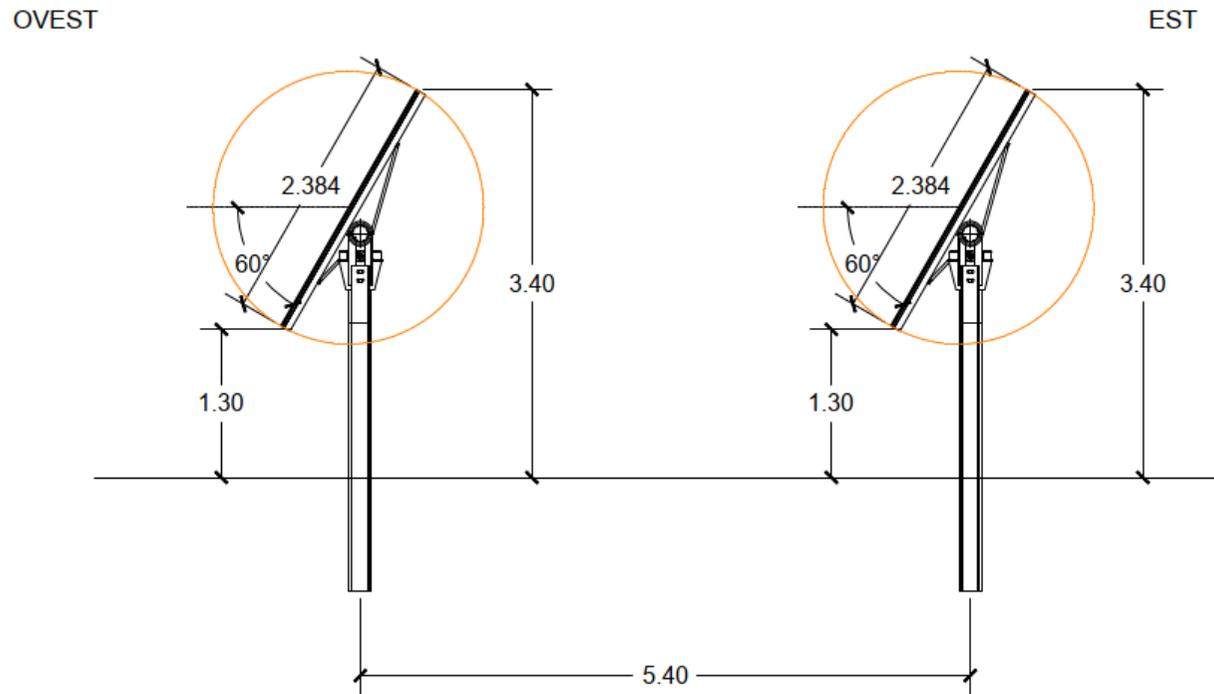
Vista laterale impianto con indicazione dell' altezza minima da terra (1,3 m) ed altezza massima 3,4 m)
